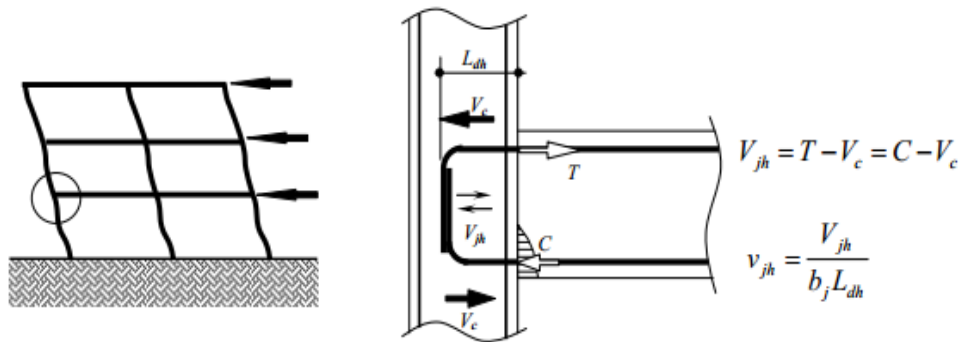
Modelo de ligação exterior pilar - viga - Osamu Joh e Yasuaki Goto [35]
